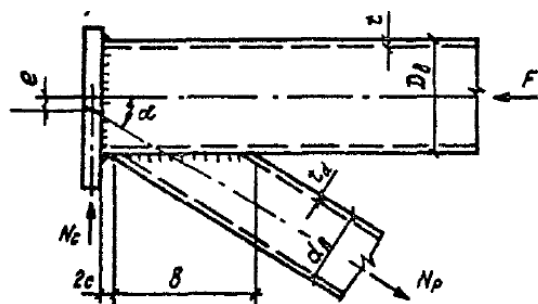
б. Расчетная схема опорного узла фермы из ГСП
